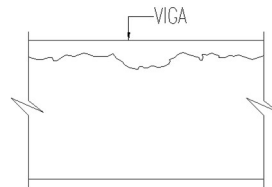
Agrietamiento en la parte superior de vigas (archivo propio)
